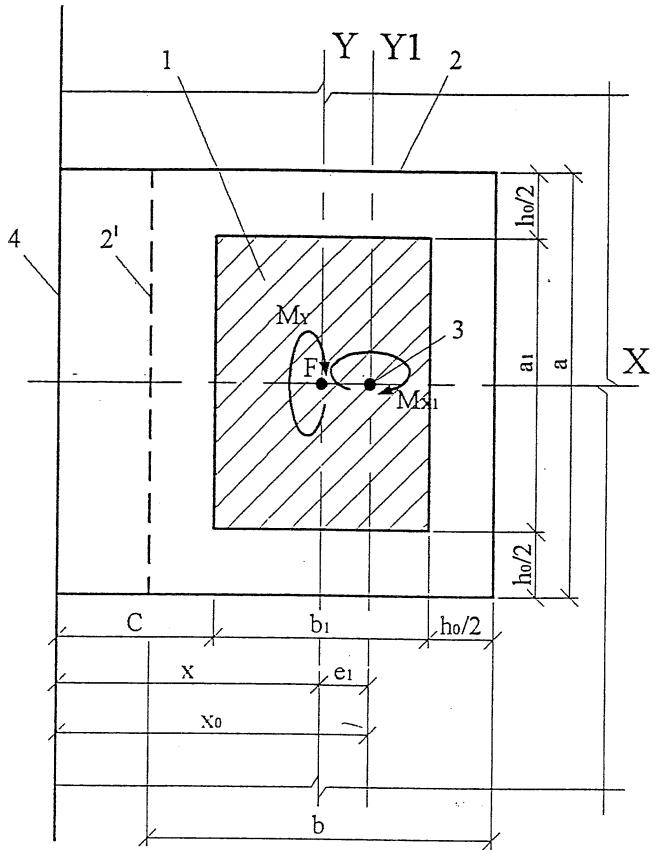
Схема для расчета железобетонной плиты на продавливание при расположении колонны у края плиты
